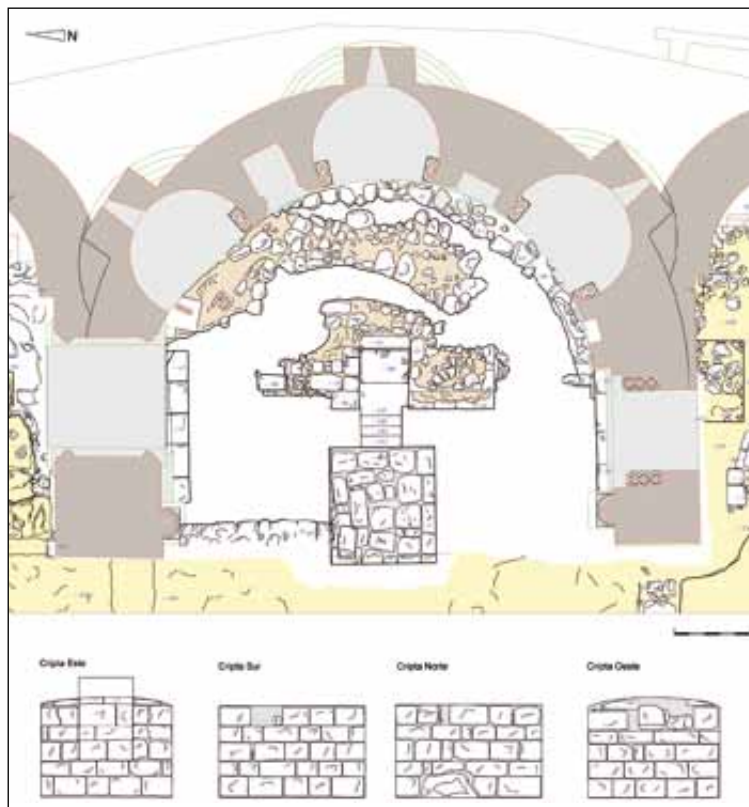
Planta y alzados de la cripta de los Mariscales de Navarra.
